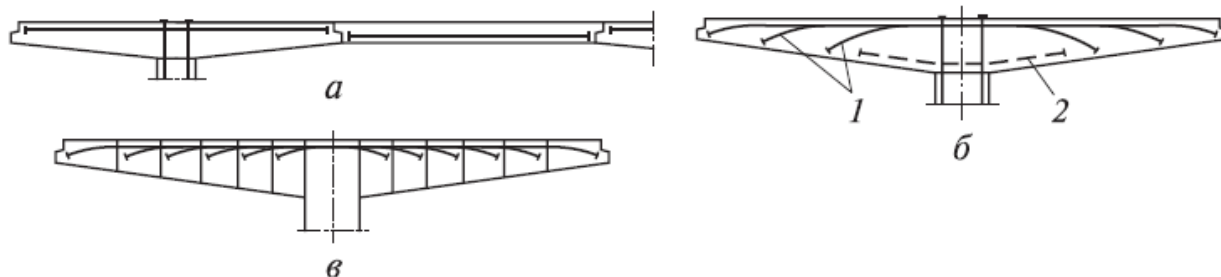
Варианты (а—в) схем армирования ригелей:
